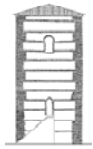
segundo tramo de escaleras situado en el interior del muro nordeste. Estas escaleras comunicaban el nivel del forjado superior de madera de la primera cámara con la segunda cámara. En él se alterna la cubrición con bóvedas de cañón apuntadas y medio cañón.
